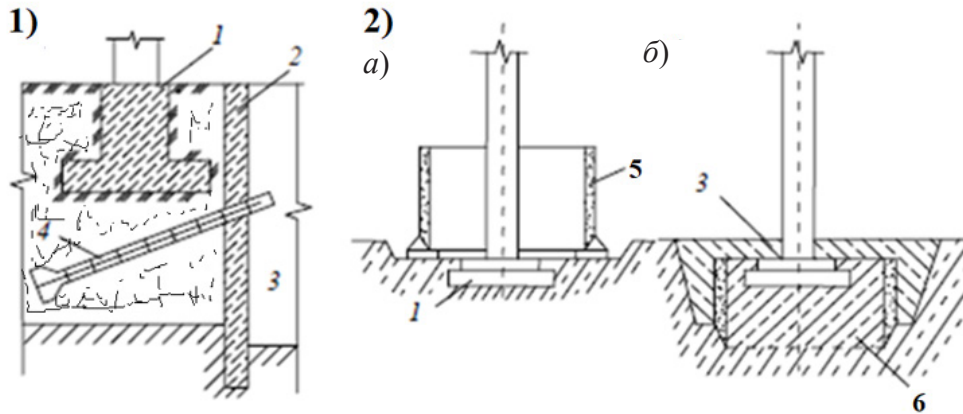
Схемы усиления фундаментов способом «стена в грунте» и опускной колодец:
